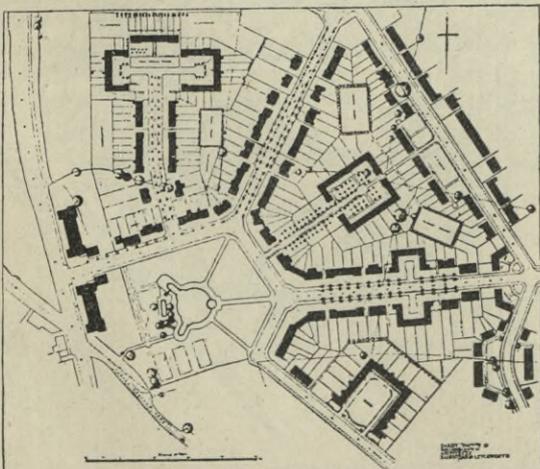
Planausschnitt aus der Gartenstadt Hampstead
